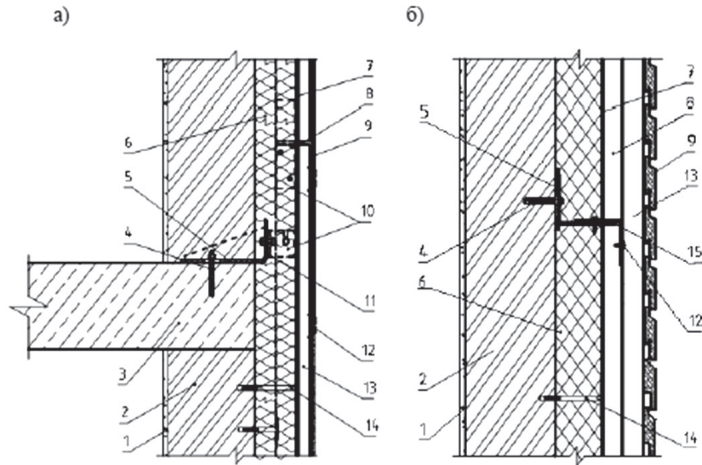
Конструктивна схема зовнішньої стіни з фасадною суцільною теплоізоляцією з опорядженням масивними (а) та легкими тонкошаровими (б) штукатурками:
